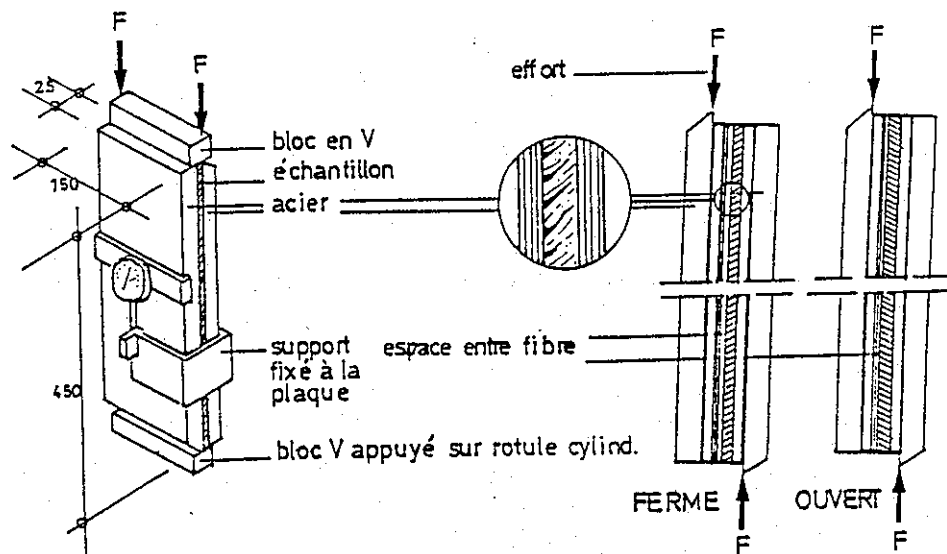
CONTREPLAQUE : CISAILLEMENT DANS LE PLAN
